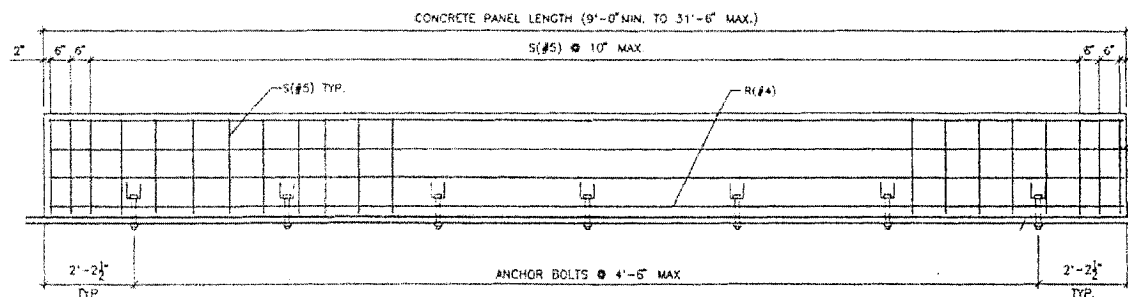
Vue en élévation du parapet original (SOLICOR SPS, 2004)
